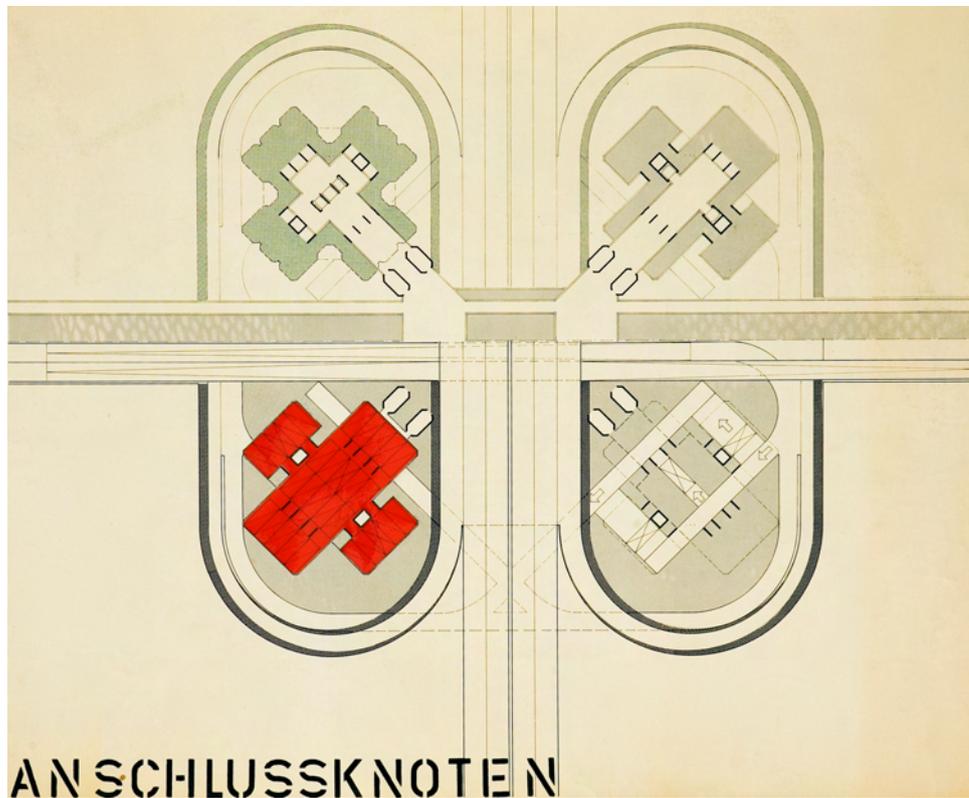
Grundriss des Knotenpunktes
